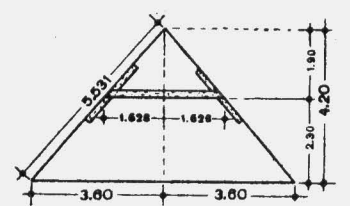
Das Hauptdachprofil zu dem Walmdach in Abbildung 1 (die Längslänge ist mit dem Apparat in Abbildung 9 ermittelt worden).
